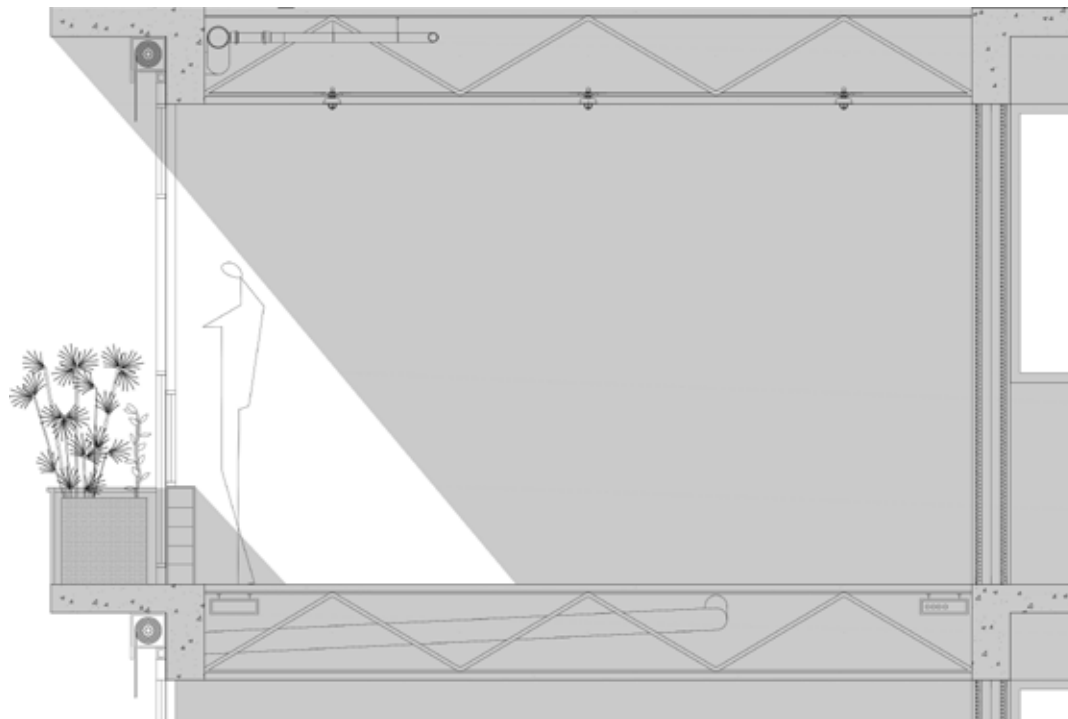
Seção típica da estrutura das faixas de apartamentos privativos.
